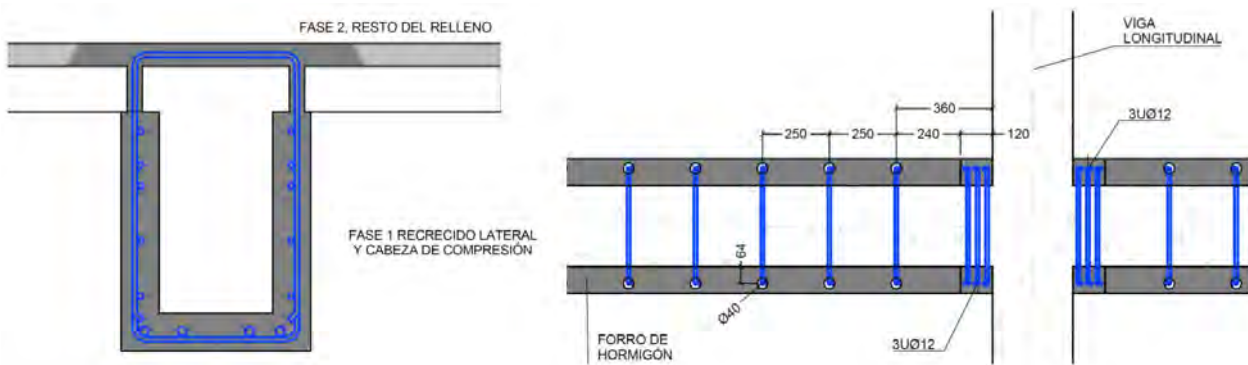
Sección de la viga transversal recrecida y detalle en planta del encuentro con la viga longitudinal.
